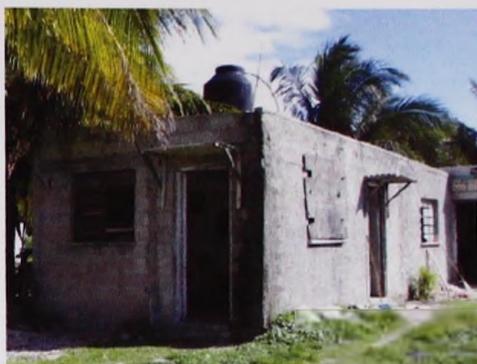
Materiales de construcción de la edificación 1 de una vivienda C1 tipo "b".
